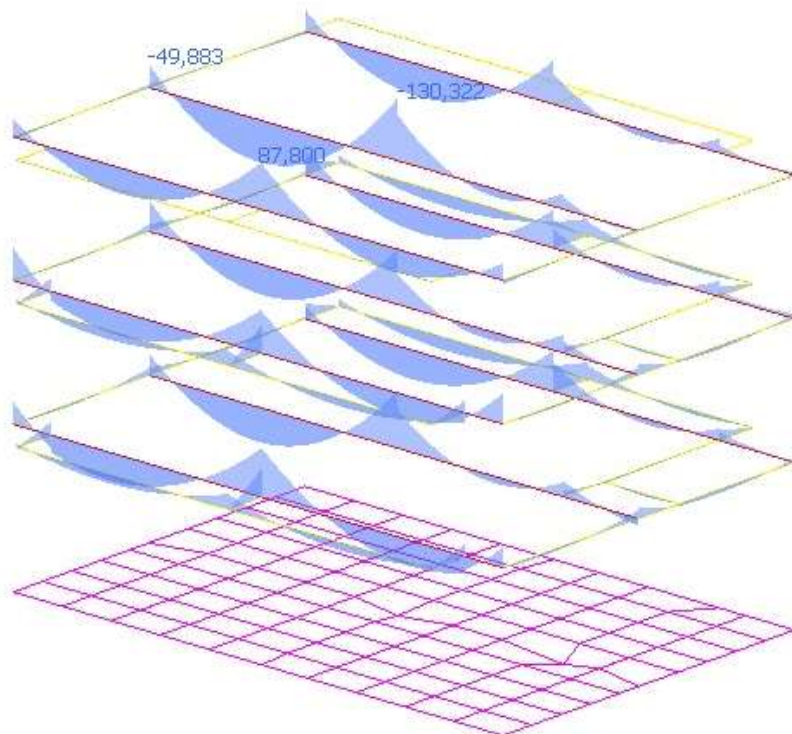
Esfuerzo flector de las vigas en la estructura propuesta
